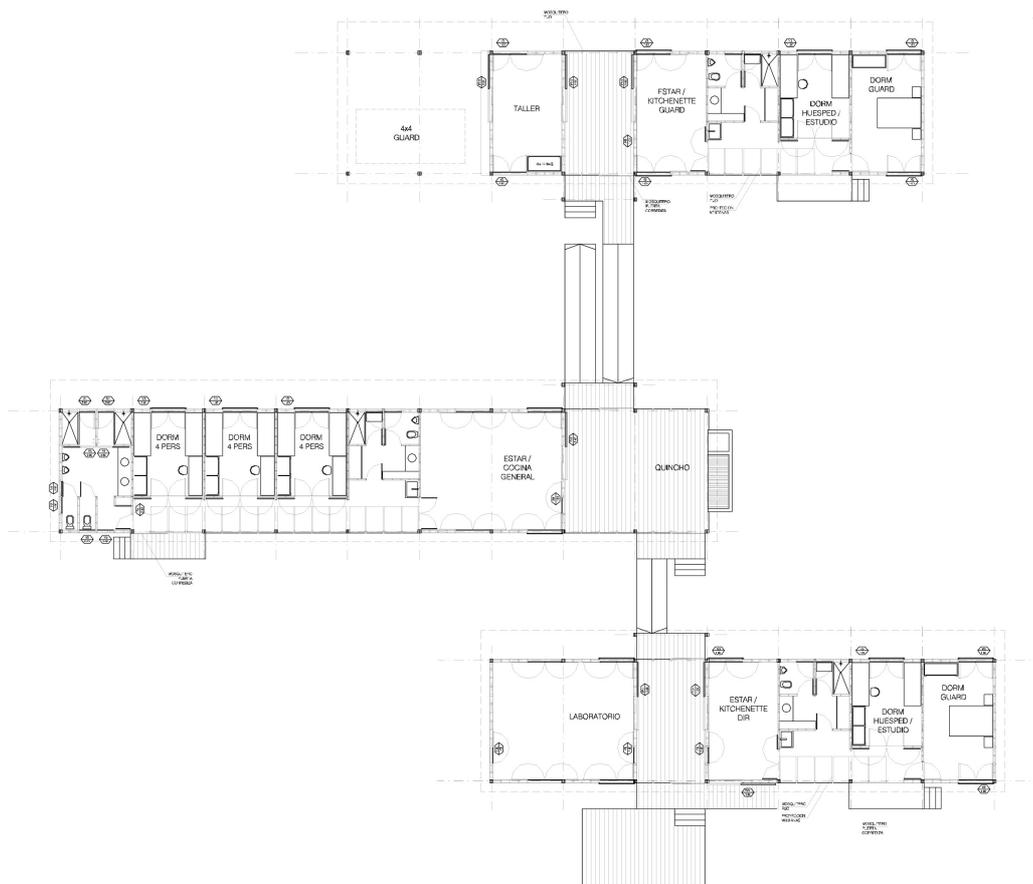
Planta del proyecto con los tres elementos unidos por una circulación techada en el sentido N - S:
